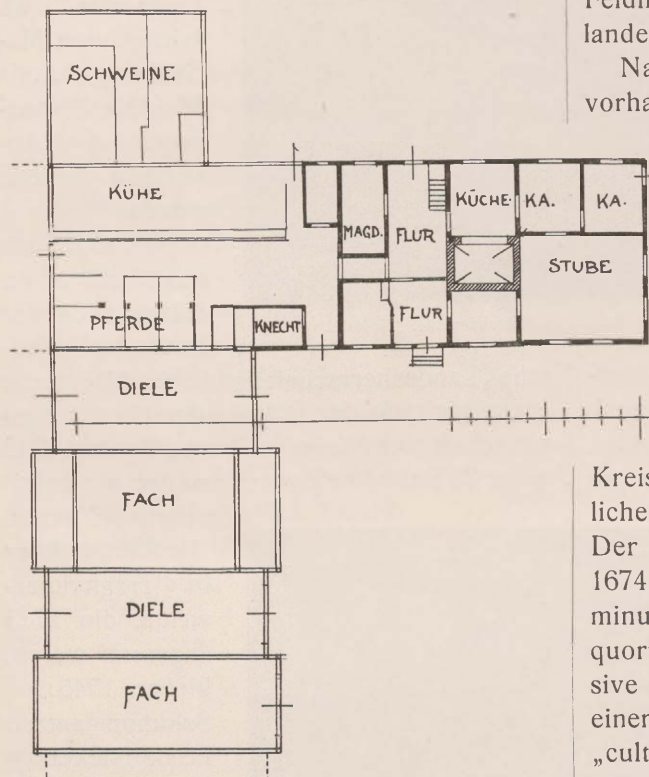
Haus Ediger in Zwanzigerweide. Grundriß. M. 1:400.
